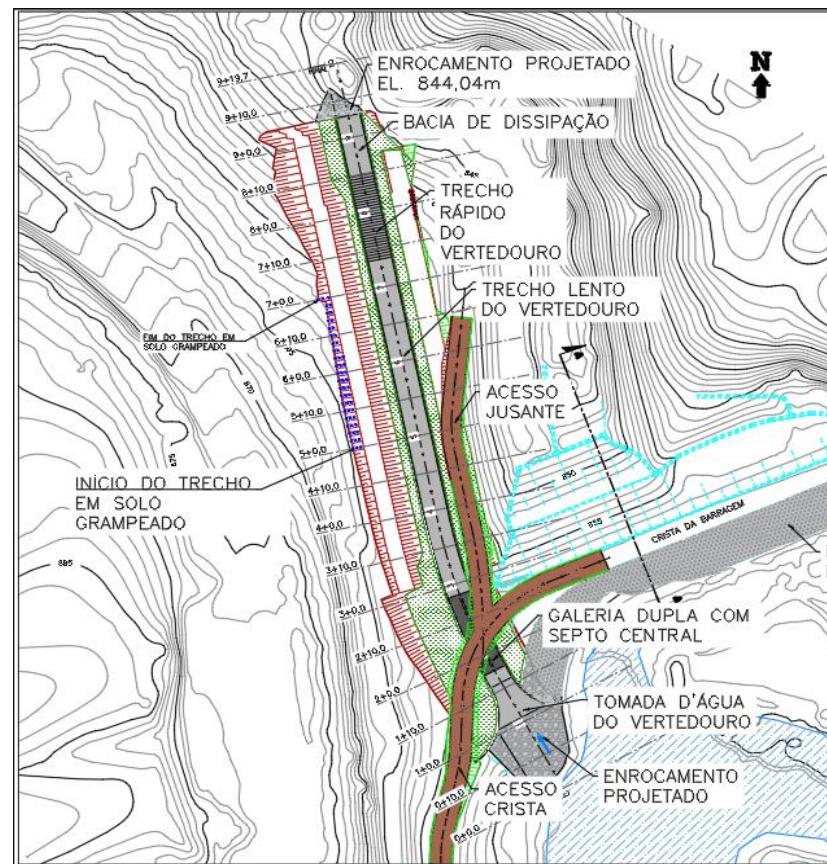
Planta com a locação das seções transversais (Estaca 0+10,00 até 9+0,00).
